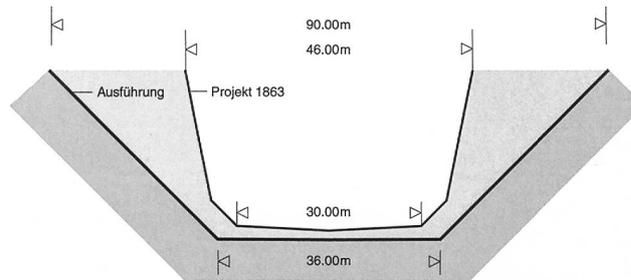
Hagneck-Einschnitt. Profil: Projekt und Ausführung (nach Peter 1922, Beilage 7).
